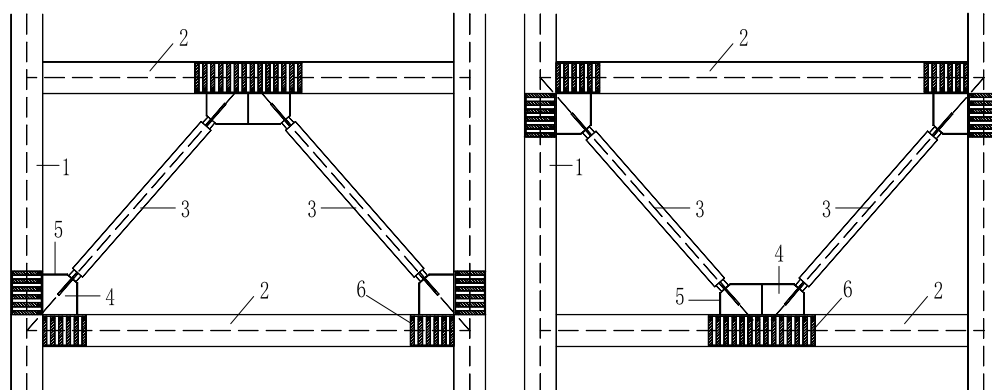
混凝土构件与屈曲约束支撑连接示意
